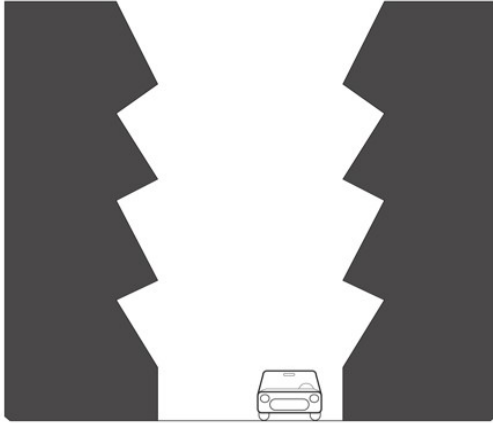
Fassadenanordnung in einer Straßenschlucht, ähnlich den von Echevarria Sanchez vorgeschlagenen Fassadenschnittbildern [53].
